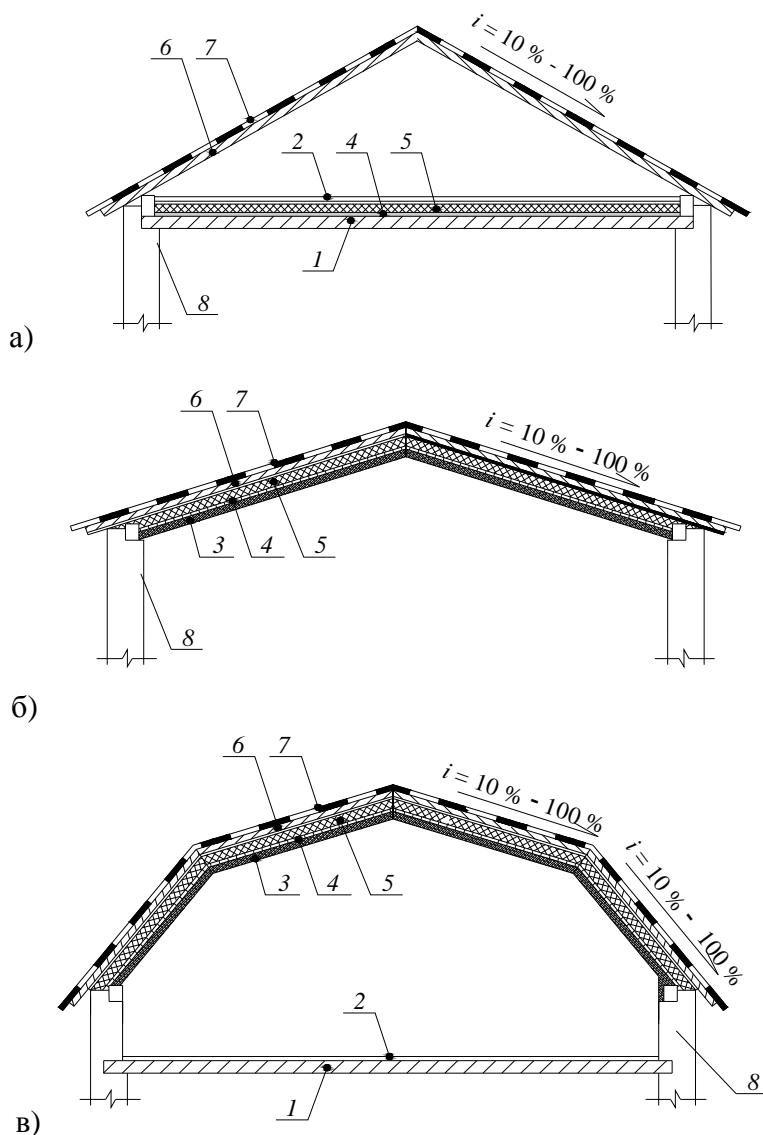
Виды скатных крыш по объемно-конструктивным решениям: а) чердачного типа; б) смешанного типа; в) мансардная крыша; 1 – чердачное перекрытие; 2 – пол; 3 – подшивка потолка; 4 – пароизолирующий слой; 5 – теплоизолирующий слой; 6 – стропильная система; 7 – гидроизоляция; 8 – стены здания
